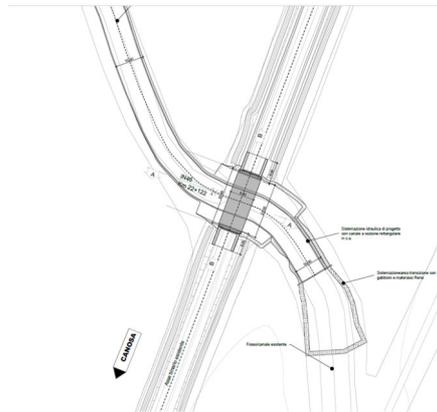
Ponte a travi incorporate IN46 – Planimetria
